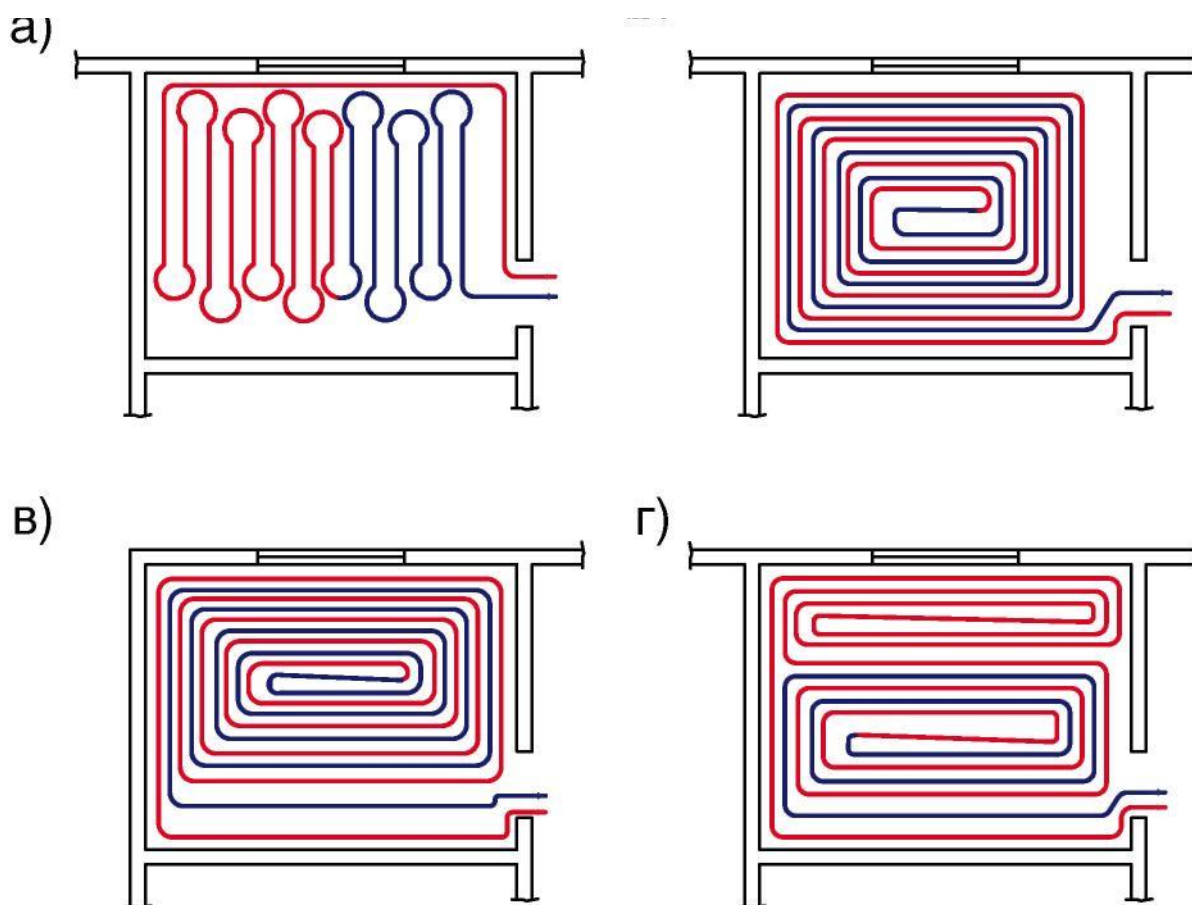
Способы укладки труб в греющем контуре напольного отопления
